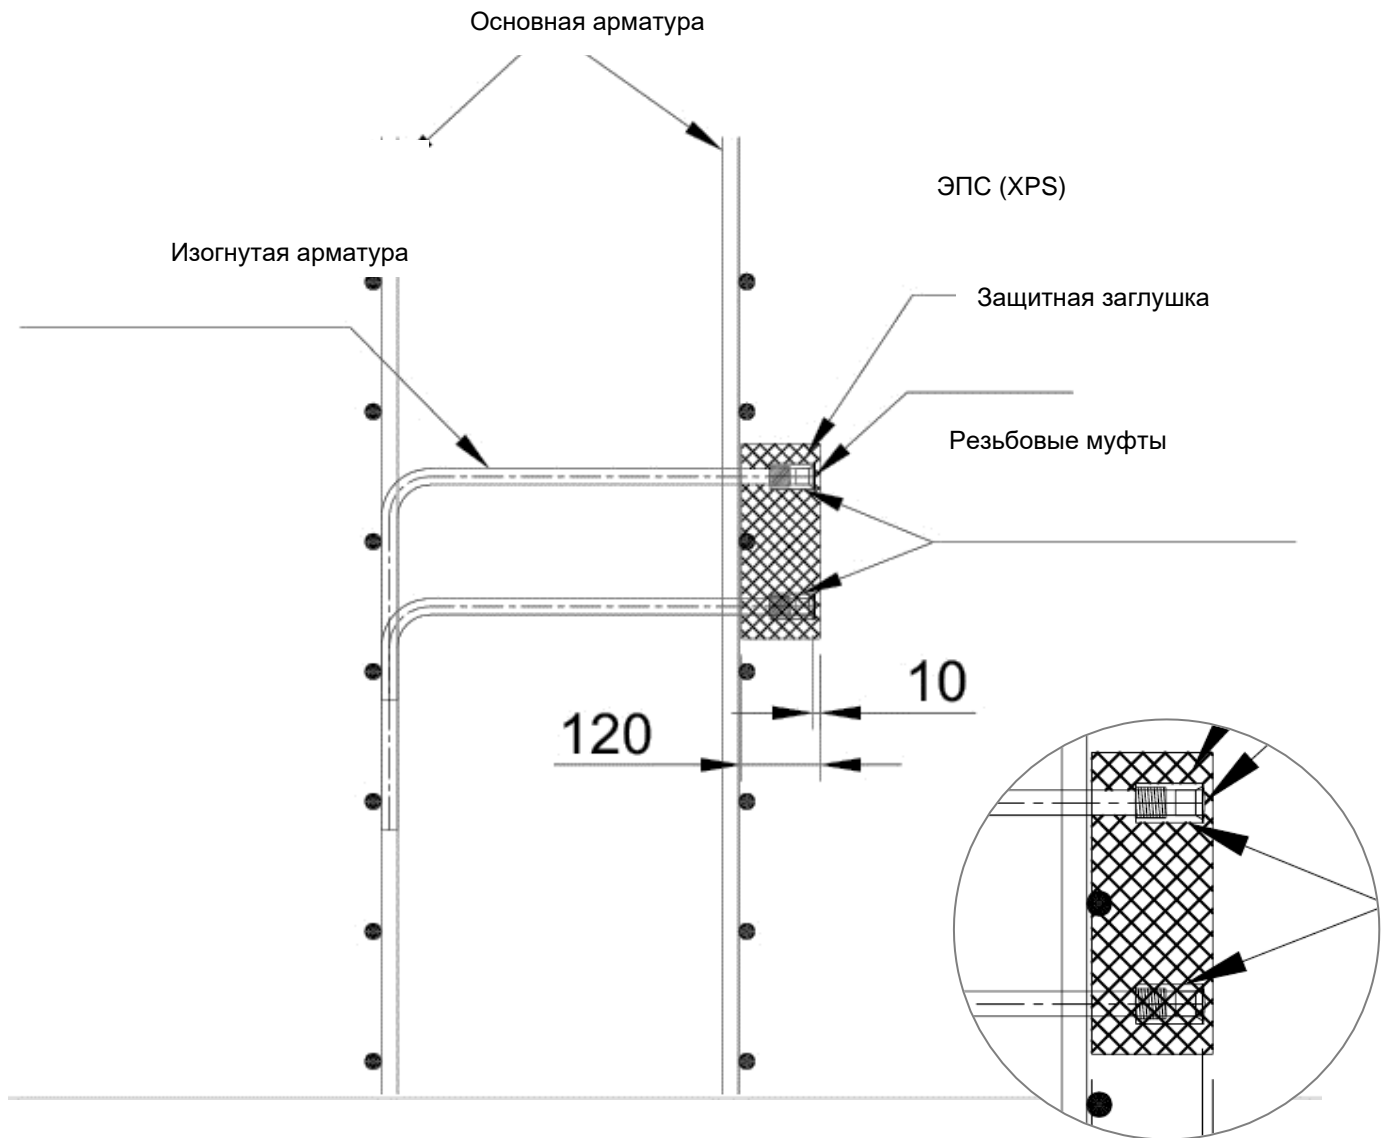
Установка соединительных муфт с защитными заглушками и плиты XPS
